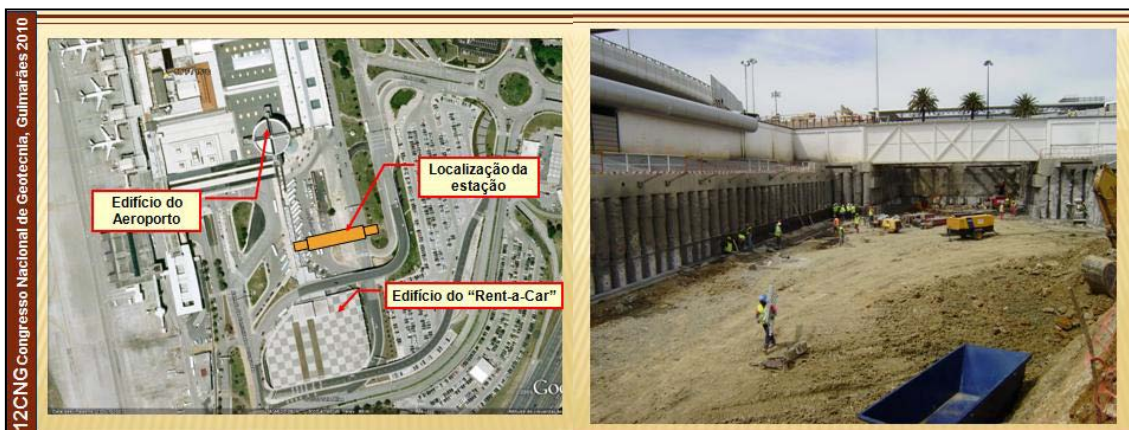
Planta da Zona de Implantação da Estação de Aeroporto e Vista do Acesso ao “Rent-a-Car”
